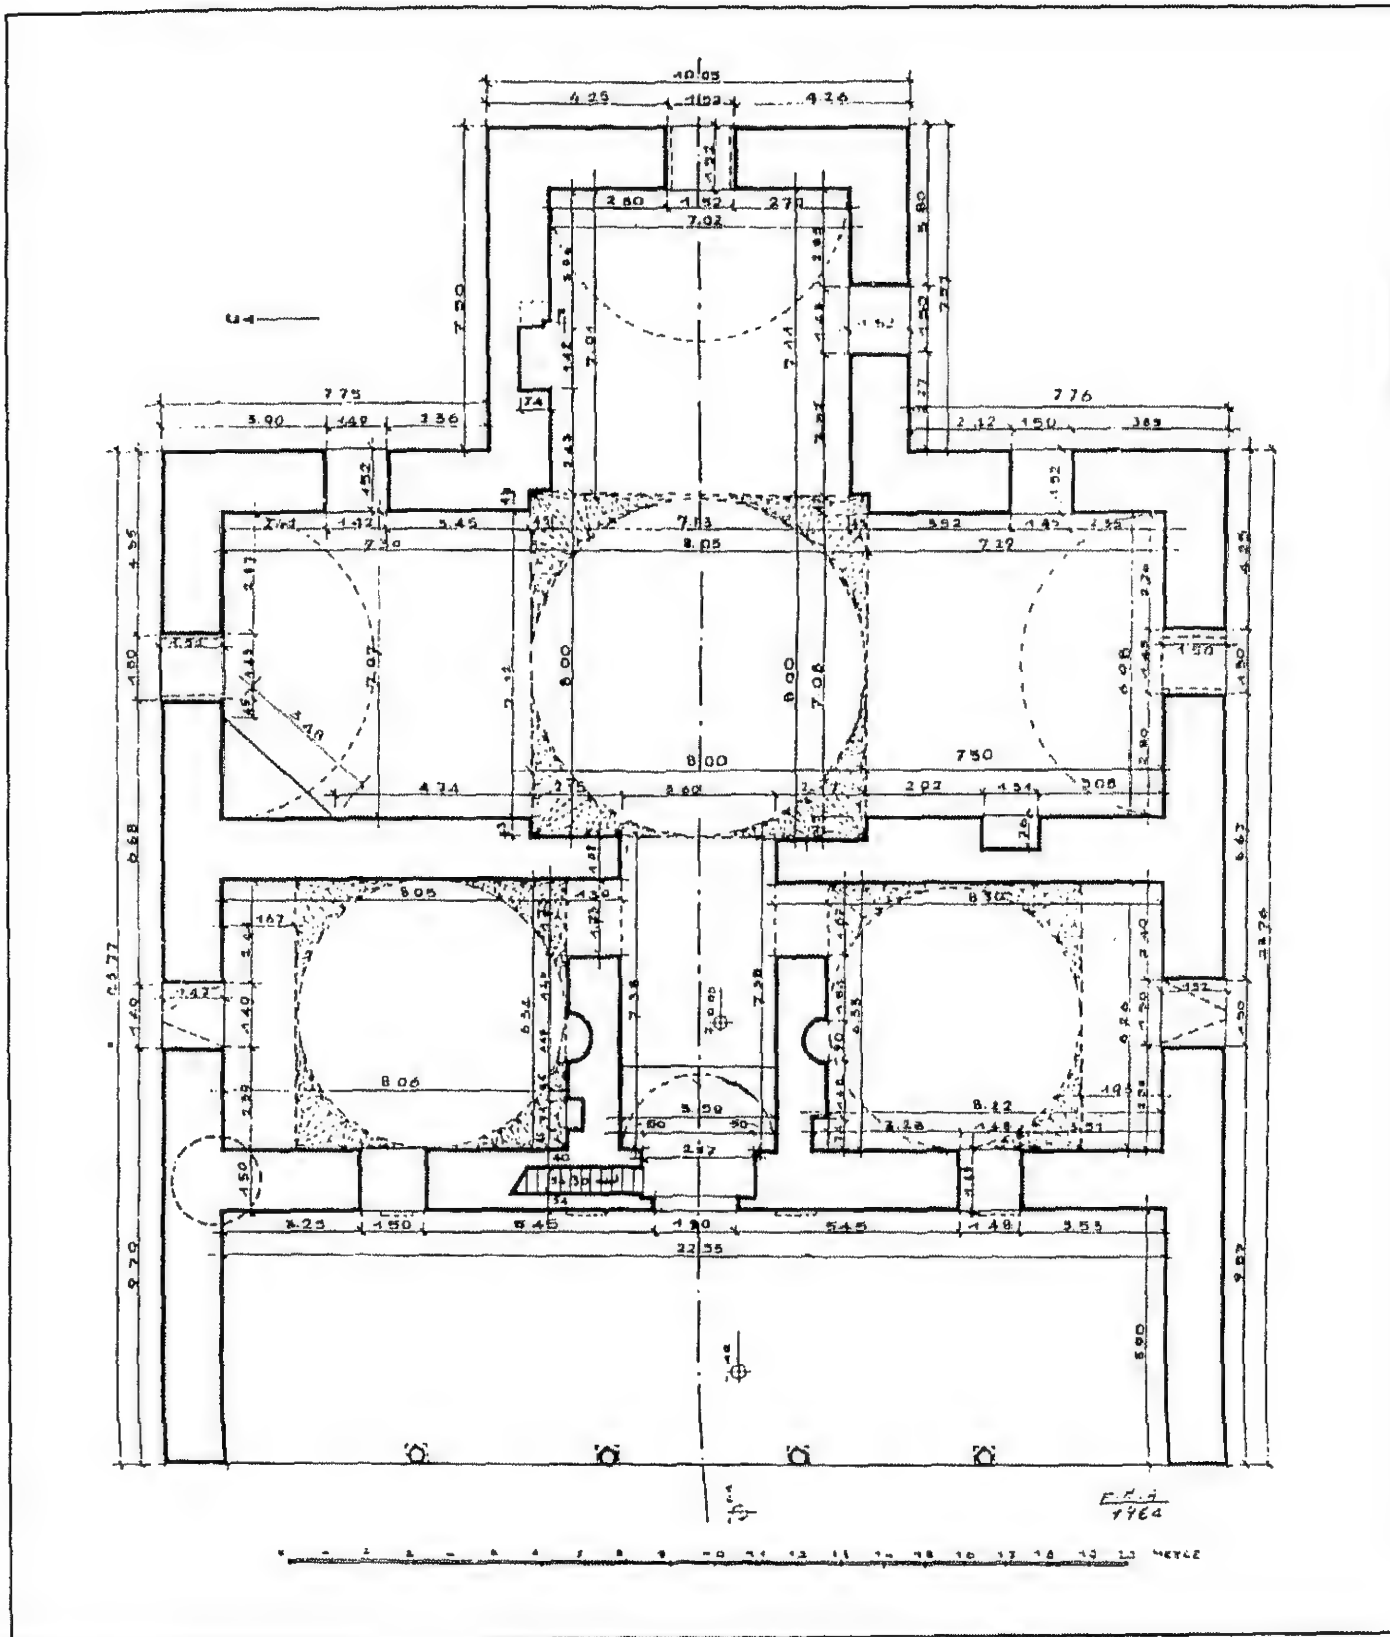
مسقط أفقي لمسجد مراد باشا في إستانبول (عن : كوران) .
